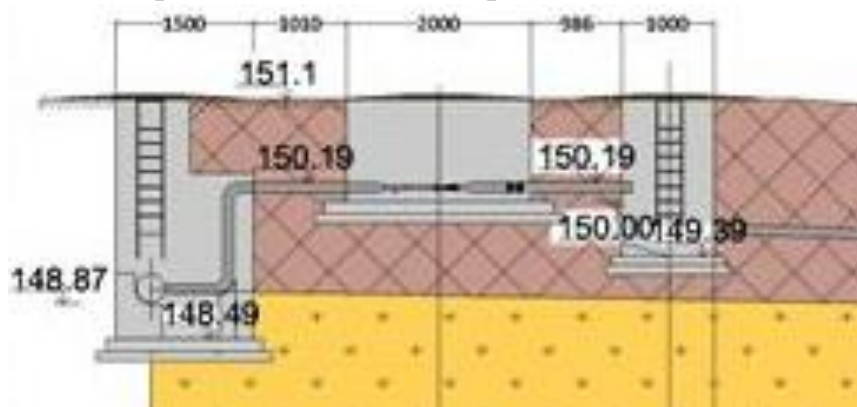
Устройство водопровода подпитки на пруду МГСУ
